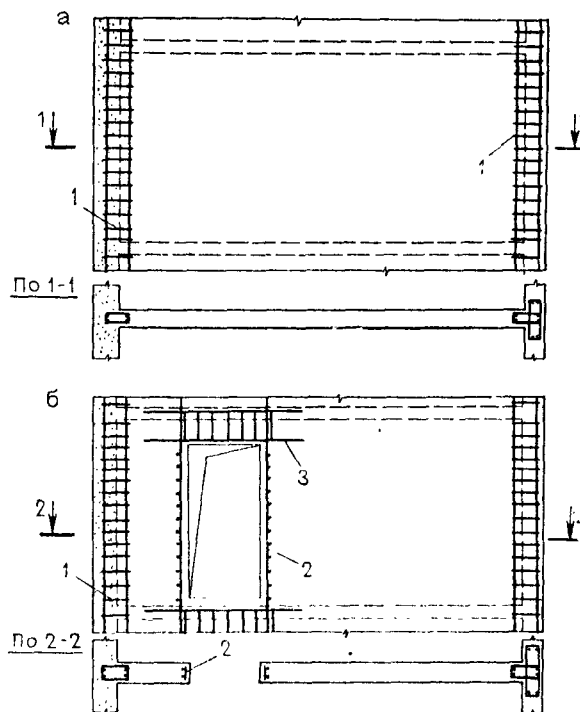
Схемы конструктивного армирования монолитных внутренних стен для обычных условий строительства
